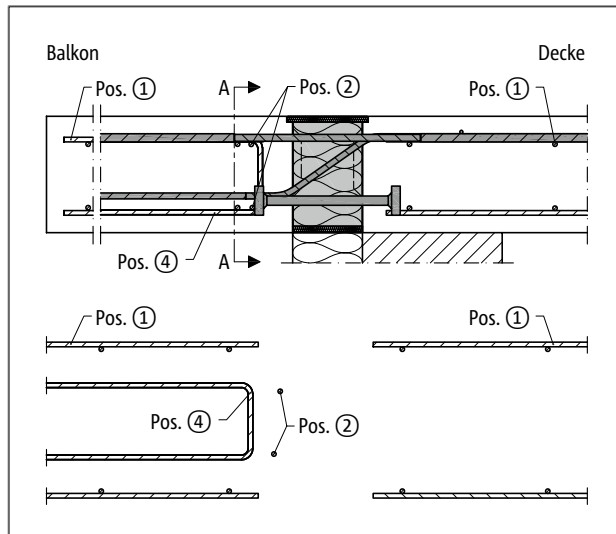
Schöck Isokorb® XT Typ K-M11: Bauseitige Bewehrung bei direkter Lagerung
